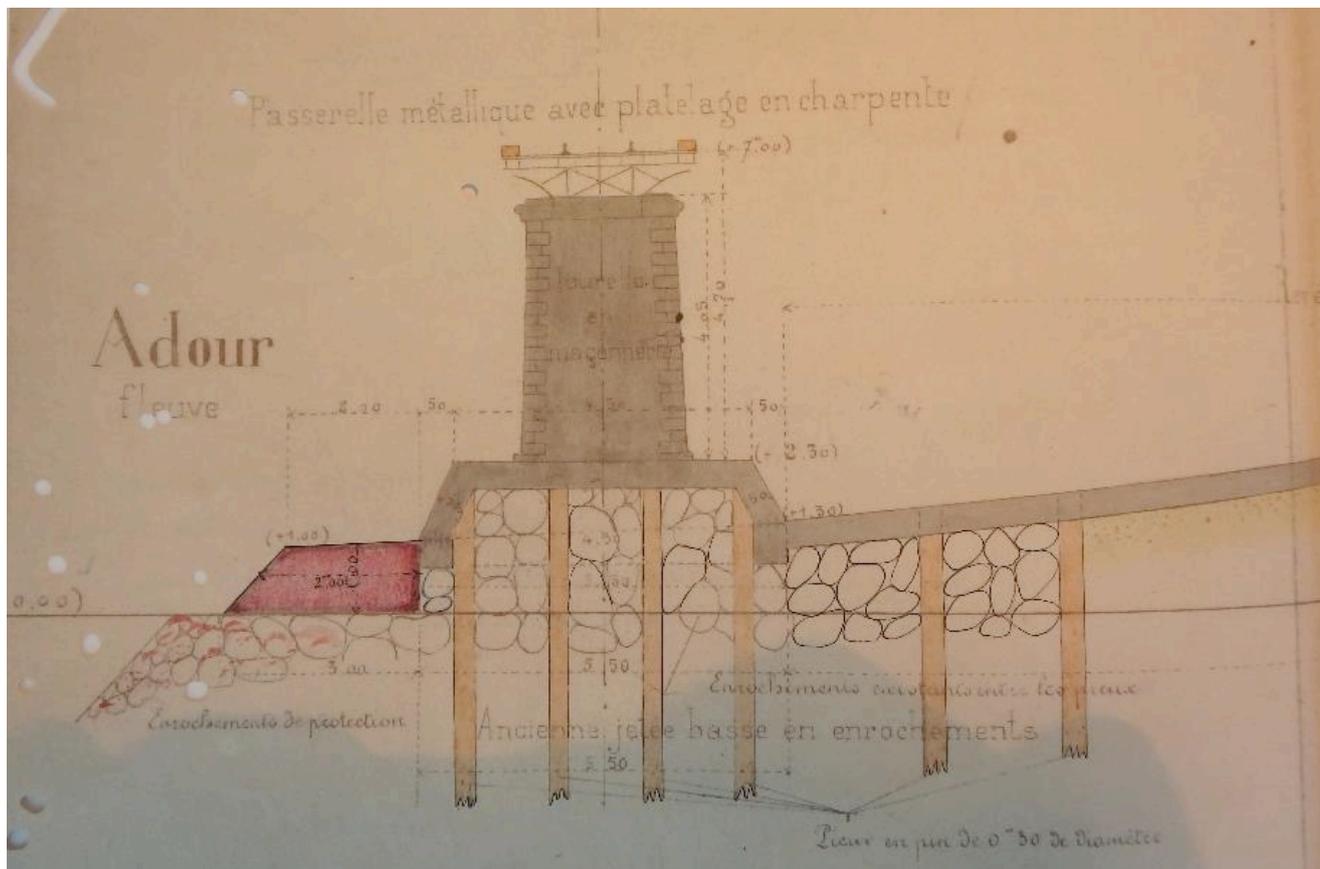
Vue en coupe des tourelles maçonnées en rive Sud
